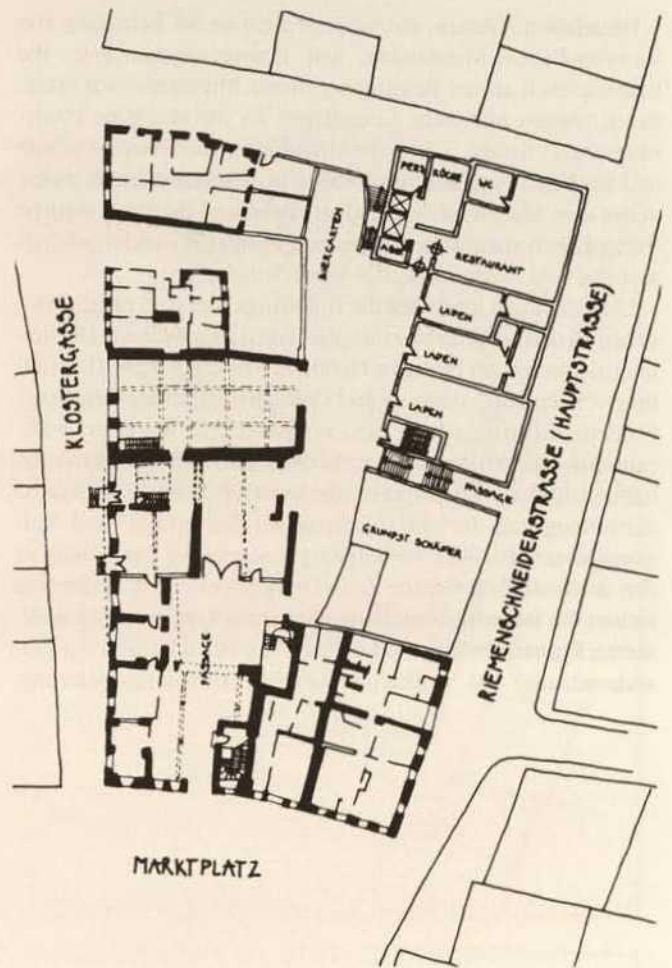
Münsterstadt, Sanierungsquartier, genehmigter Bebauungsplan.
